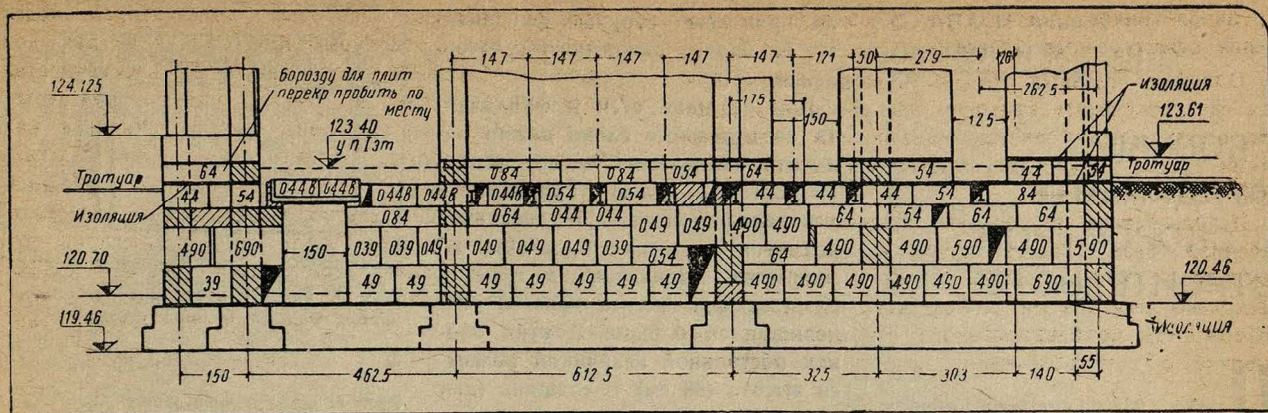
Развертка стены крупноблочного жилого дома со сборными фундаментами на Дербеневской набережной.
